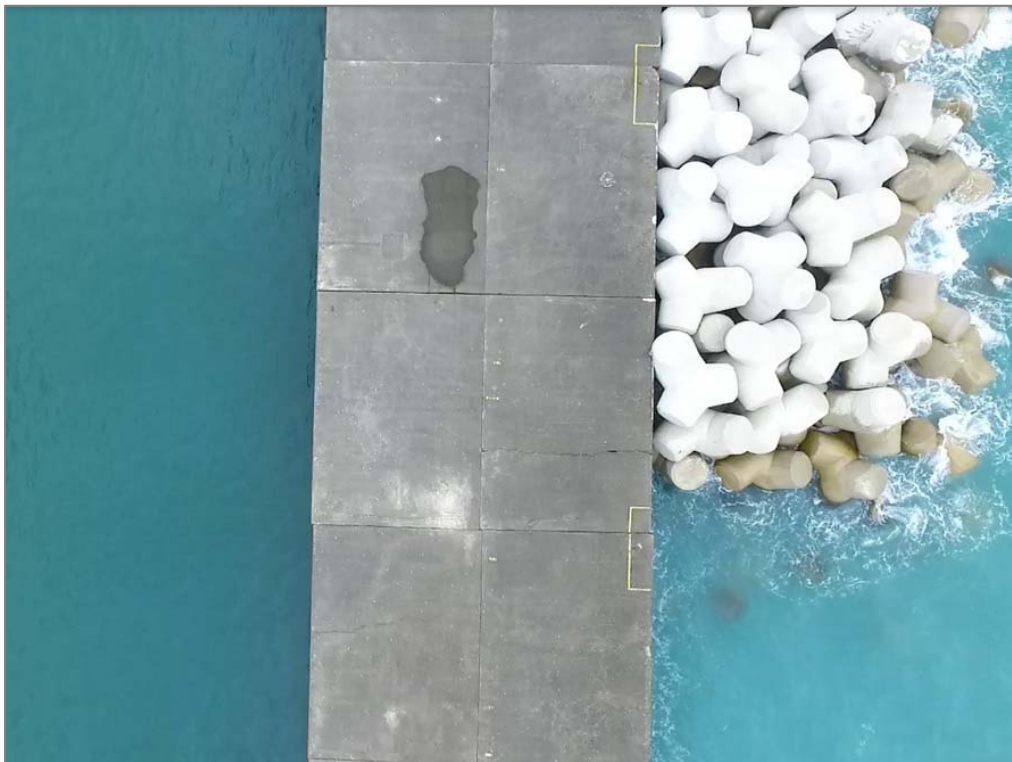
上部工のひび割れ(高度約50m)
